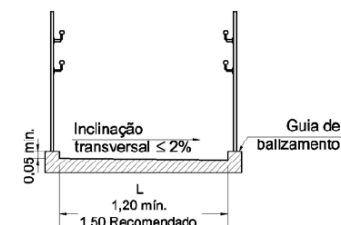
Inclinação transversal e largura de rampas – Exemplo.
